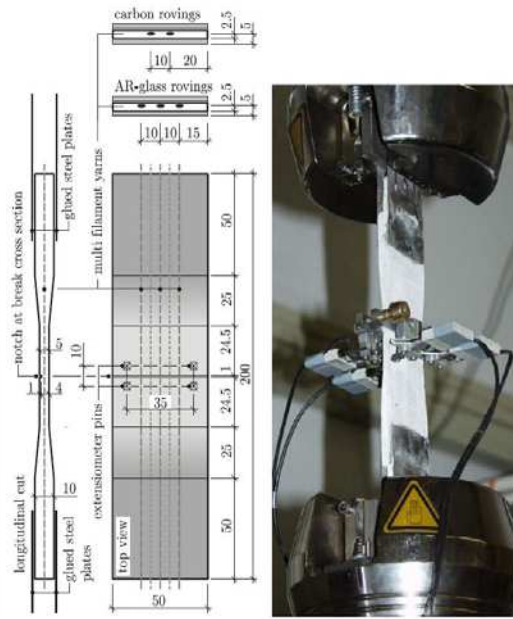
Essai d'arrachement à double longueur ancrage [SCHEFFLER\_09]
